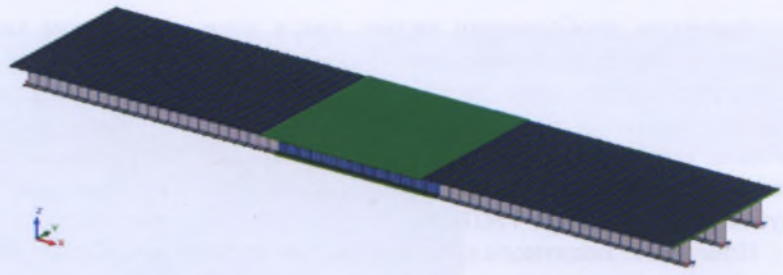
Расчетная схема железобетонного пролетного строения длиной 33,0 м
